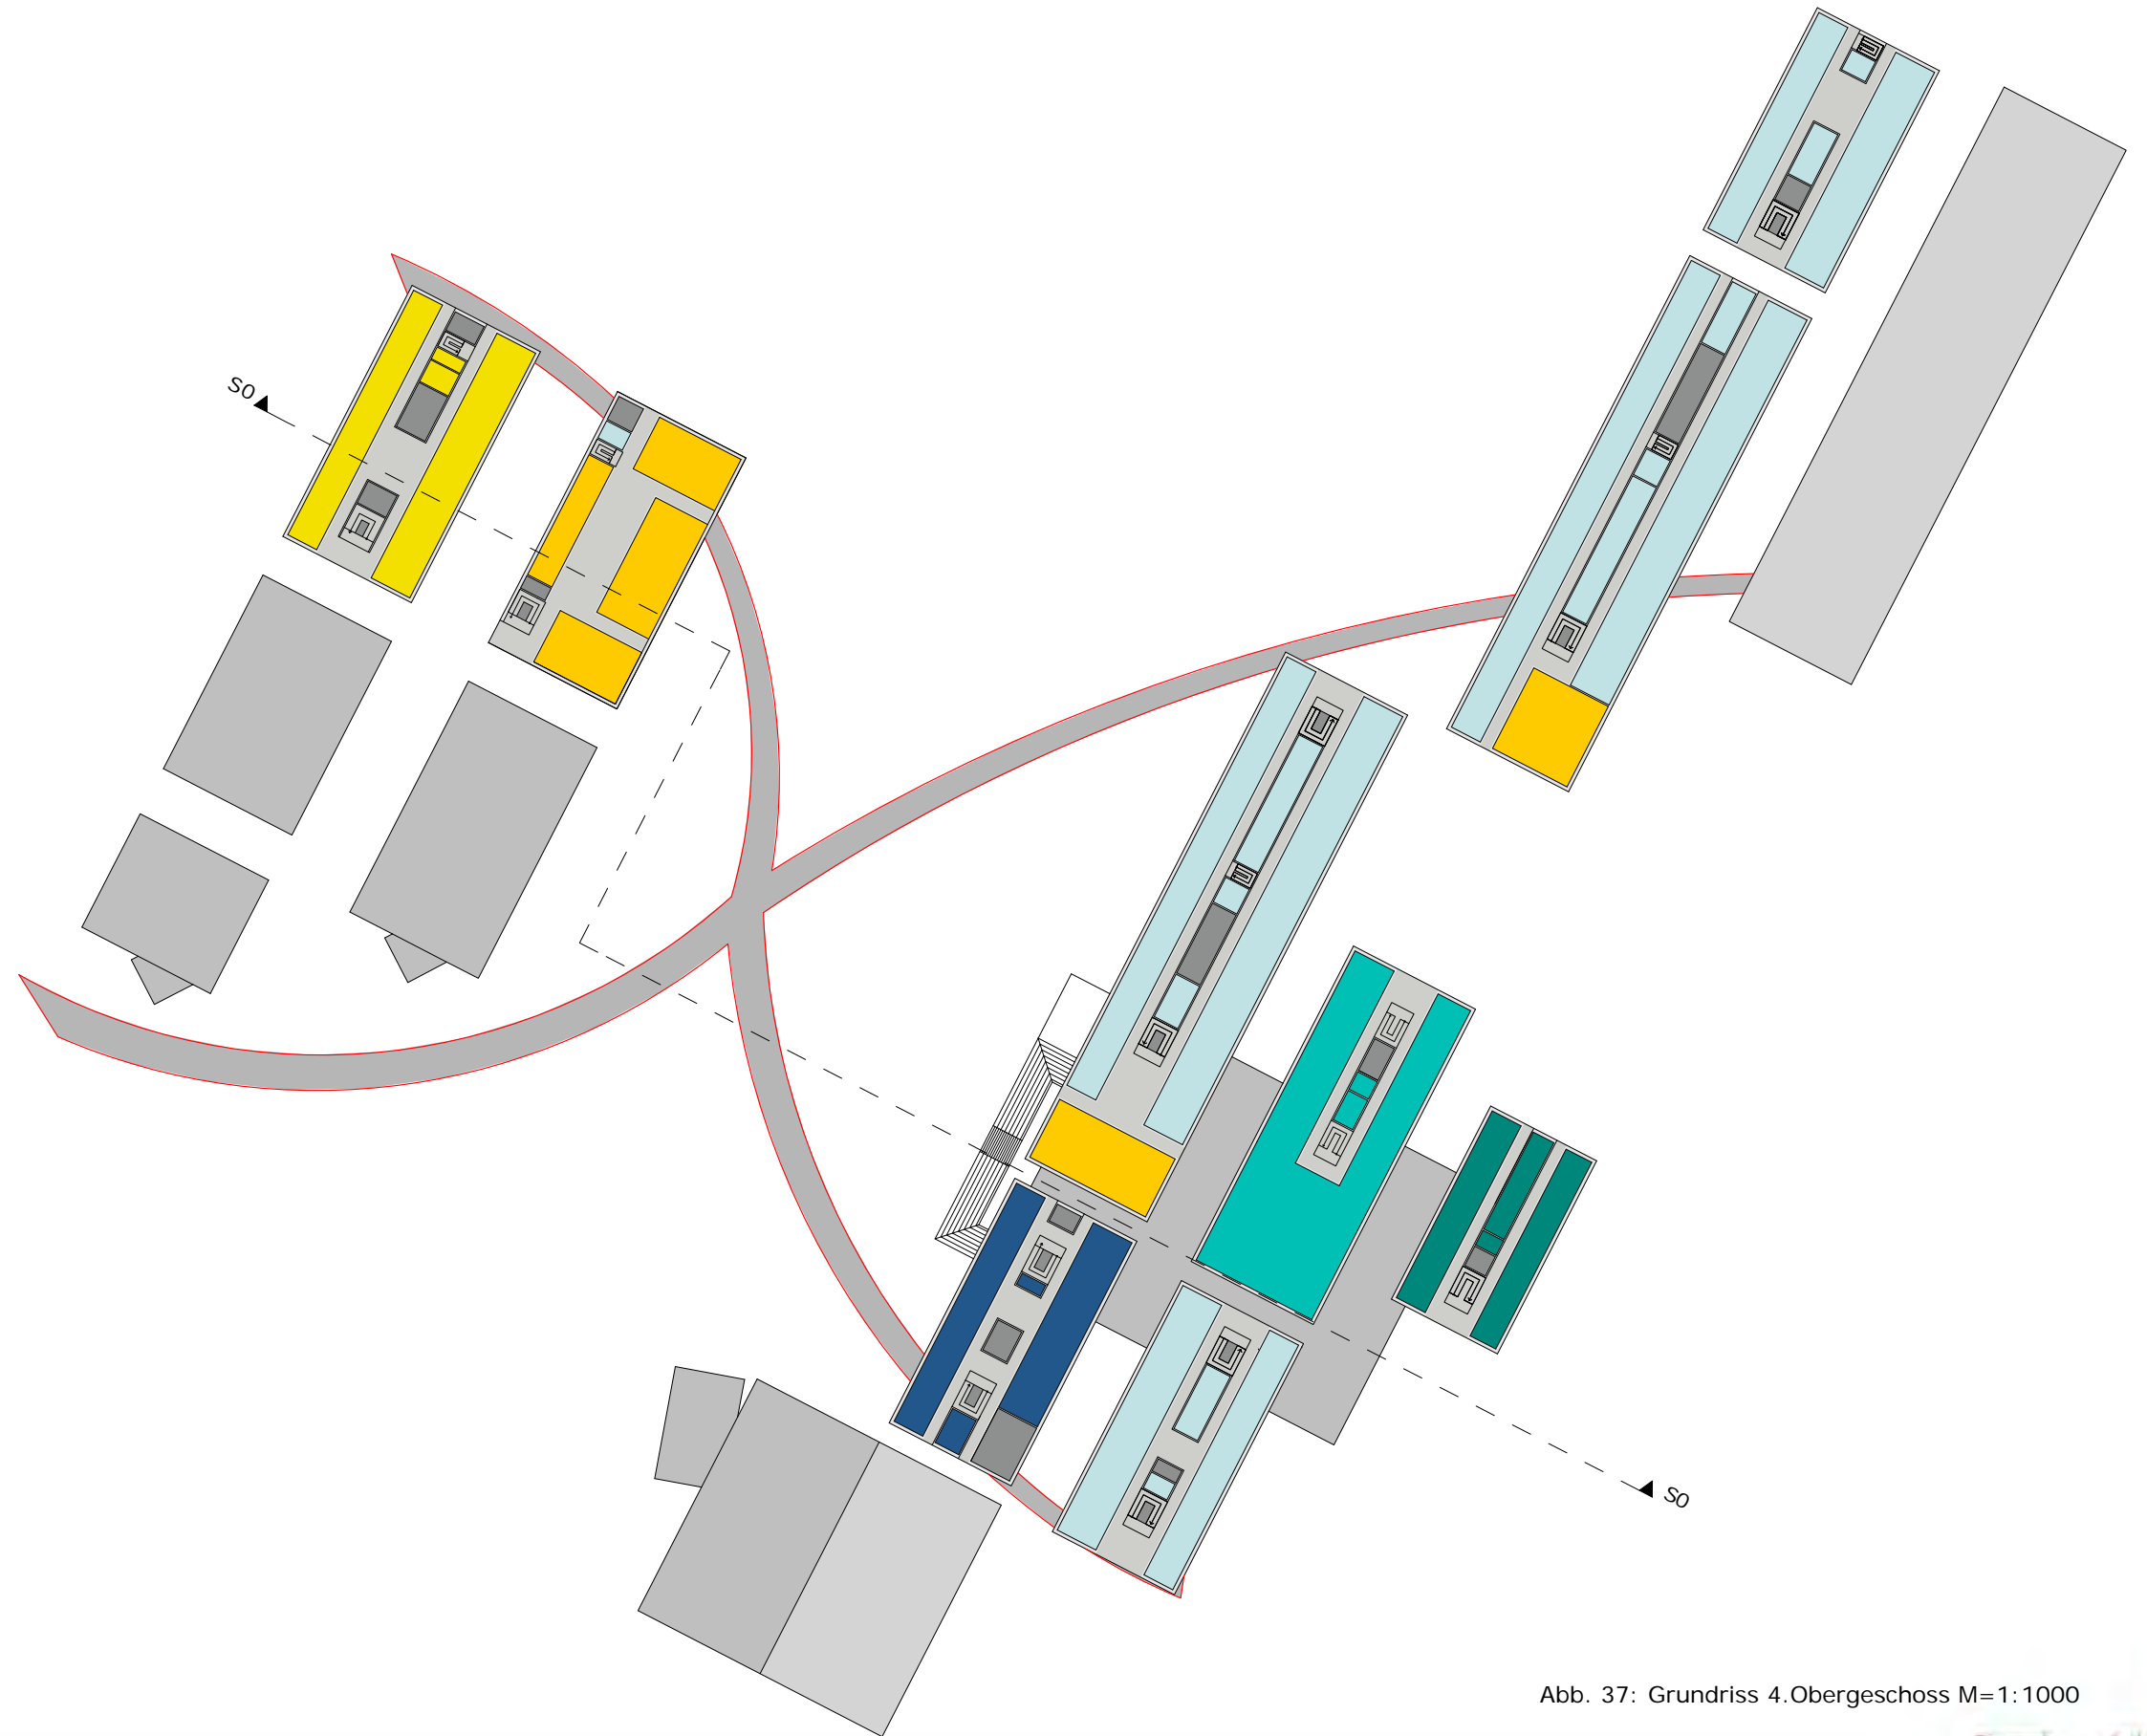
Grundriss 4. Obergeschoss M=1:1000
